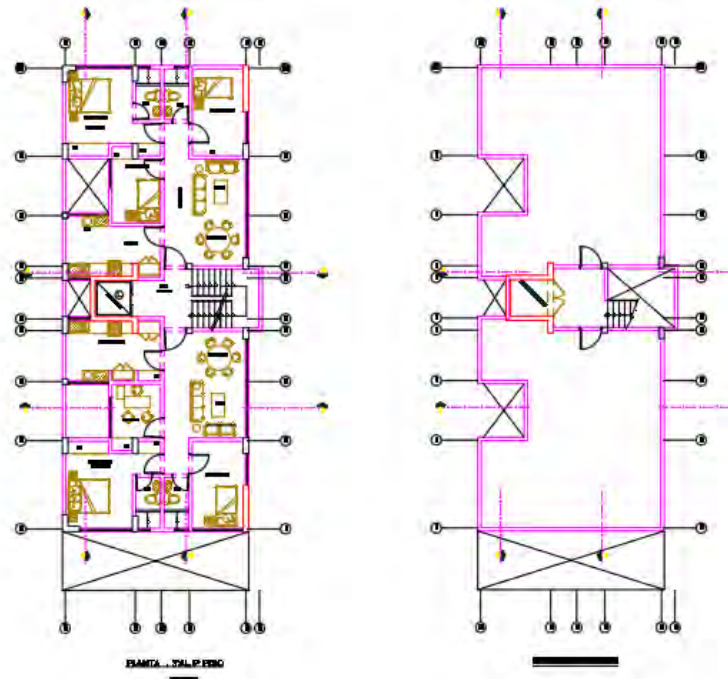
Vista en planta del tercer a quinto nivel, y planta de azotea
